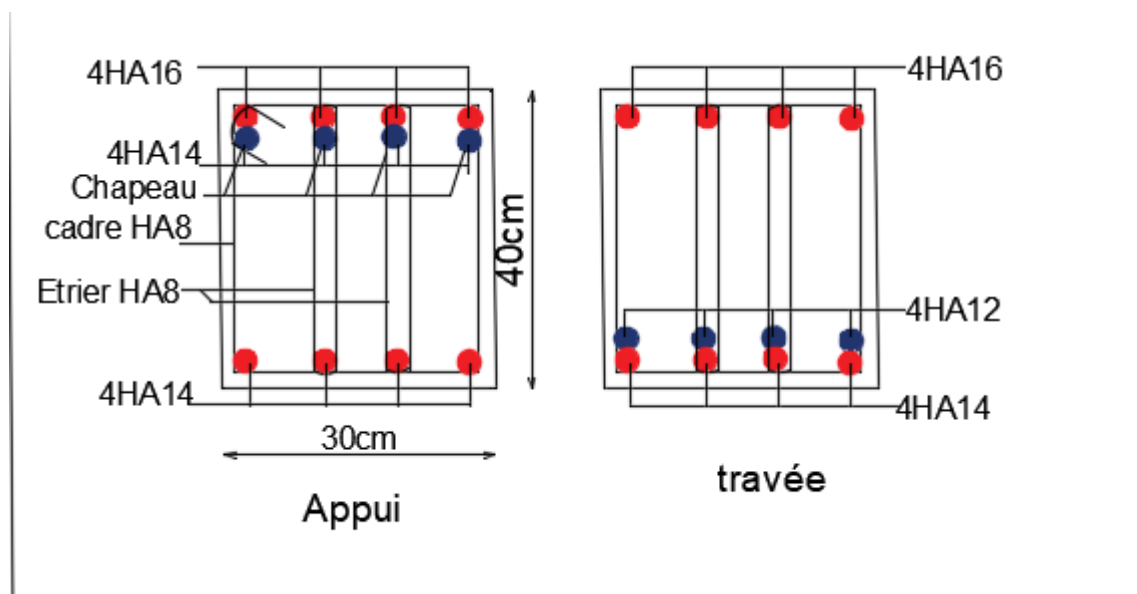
Schéma de ferrailage de la poutre principale du plancher étage 2
